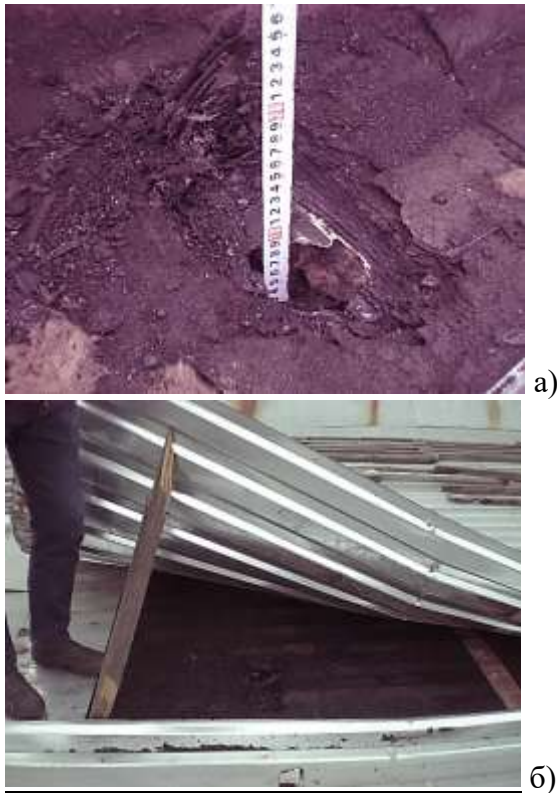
Дефекты и повреждения гидроизоляционного ковра и металлических профлистов по гидроизоляционному ковру: а) – гидроизоляционный ковер насчитывает 11 слоев рубероида, нижние слои и мастика полностью разрушены; б) поверхностная коррозия элементов ферм.
